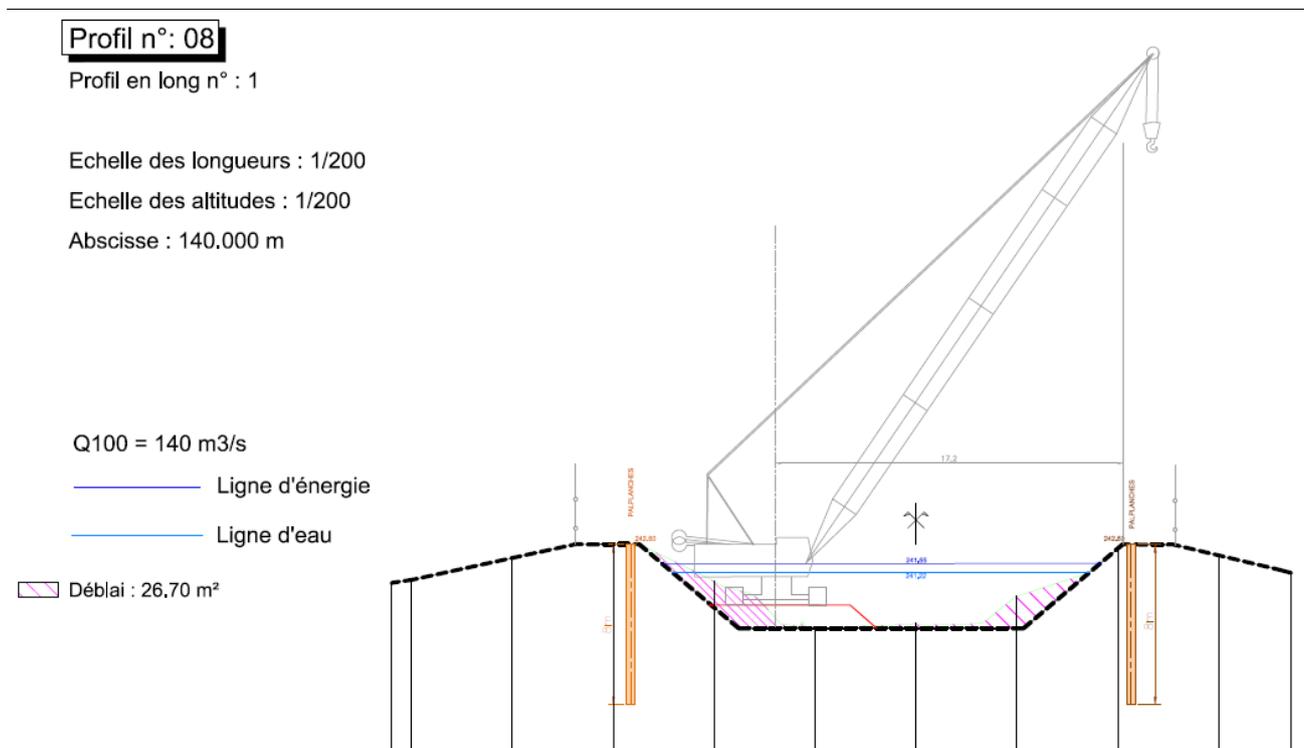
Mise en œuvre des palplanches au moyen d'une grue installée sur la piste d'accès en rive gauche (Source : PRO Safège, avril 2018)
